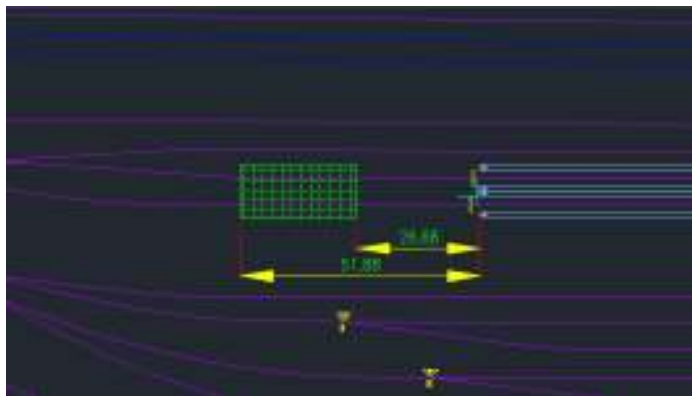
Ubicación de seccionadores en playa de lavado del lado norte
